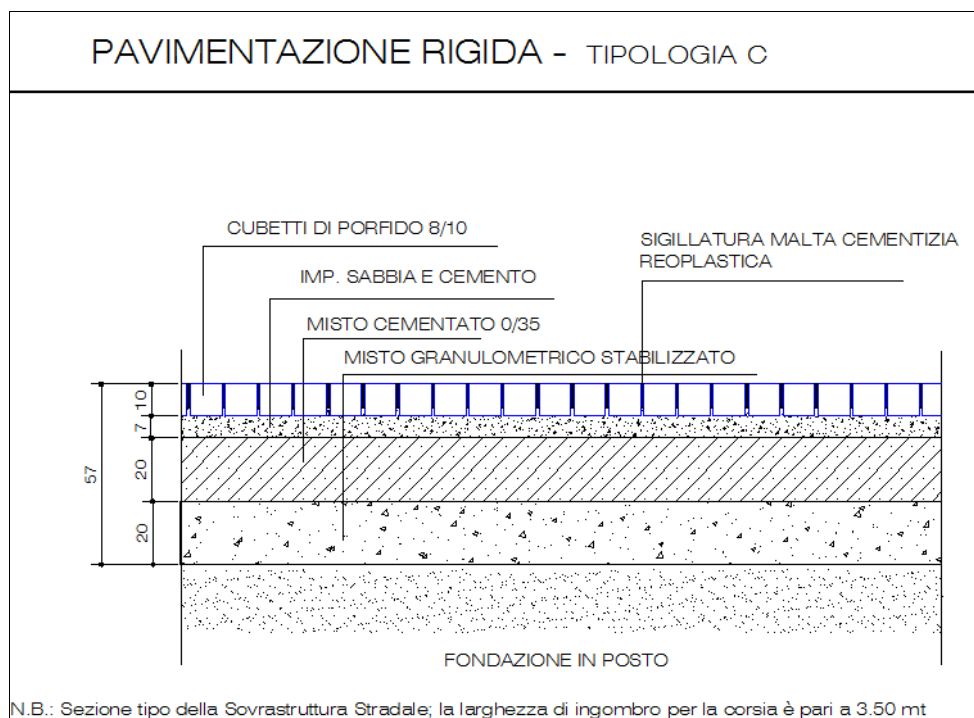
Pacchetto C per pavimentazione in pavè senza soletta in calcestruzzo
